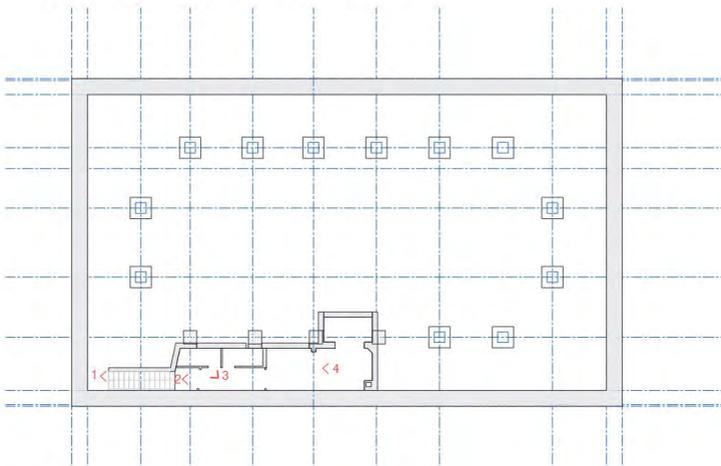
Plan de sous-sol. Atelier Féroué 2017.
